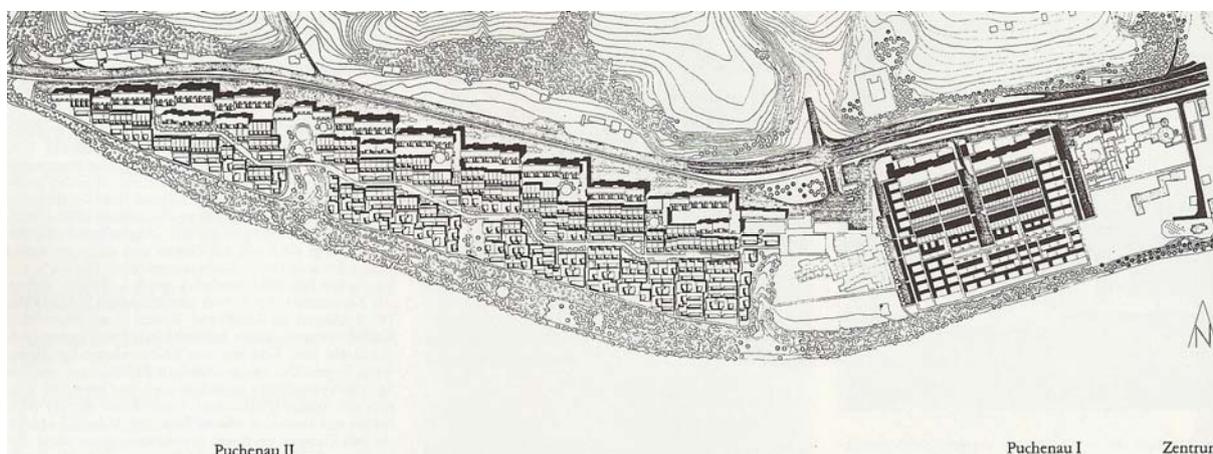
Lageplan Gartenstadt Puchenuau I & II
